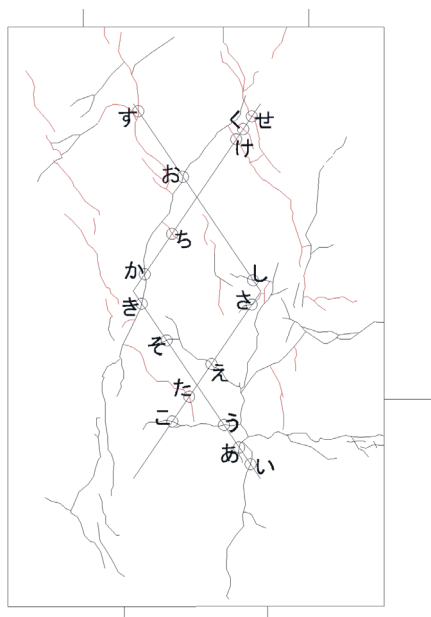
パイルキャップひび割れ幅測定位置 (試験体 D-2 正載荷)
